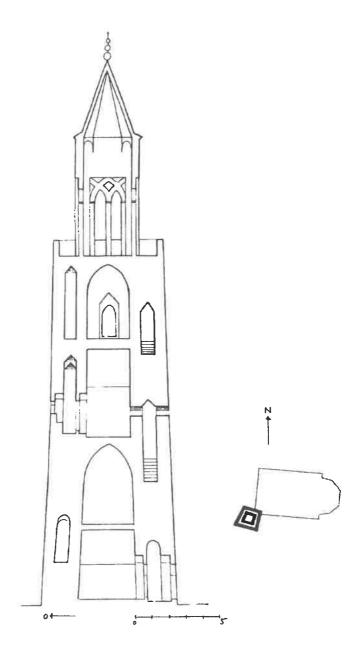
Ateca, sección central NO-SE y relación en planta con la iglesia mudéjar.
